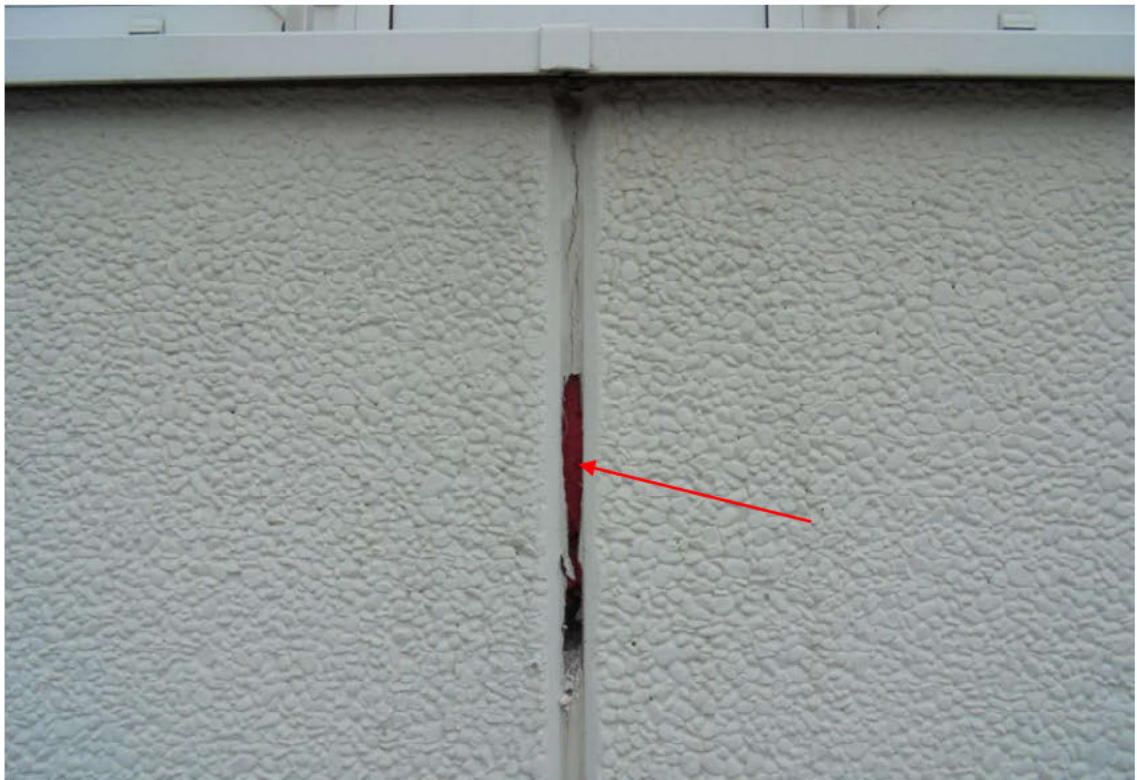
Gebäude K9, Fassadenplatte mit Fuge
